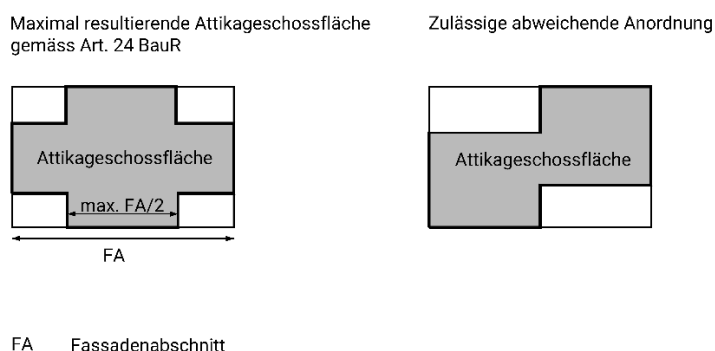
Attikageschoss mit möglicher Anordnung innerhalb Bruchteils je Fassadenabschnitt gemäss Regelbaumassstabelle.
